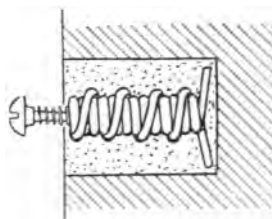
En techos de caña y muros de ladrillo hueco se emplean espigas de doble espiral sujetas con mortero de yeso.
